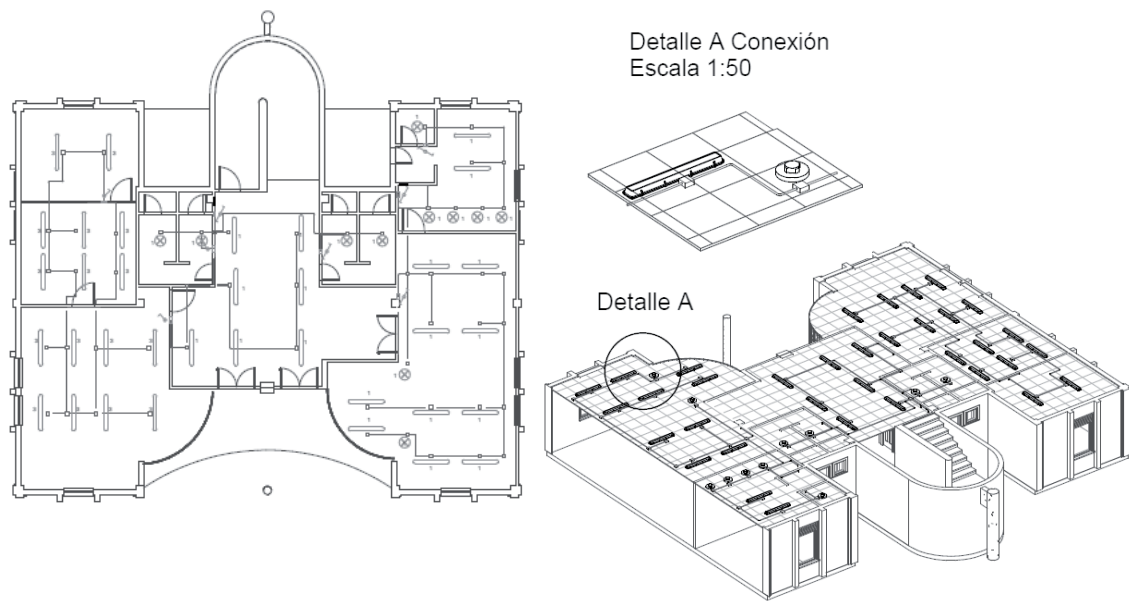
Planta Baja Instalación de Iluminación, Isometría y Detalle. Fuente: Elaboración propia.
